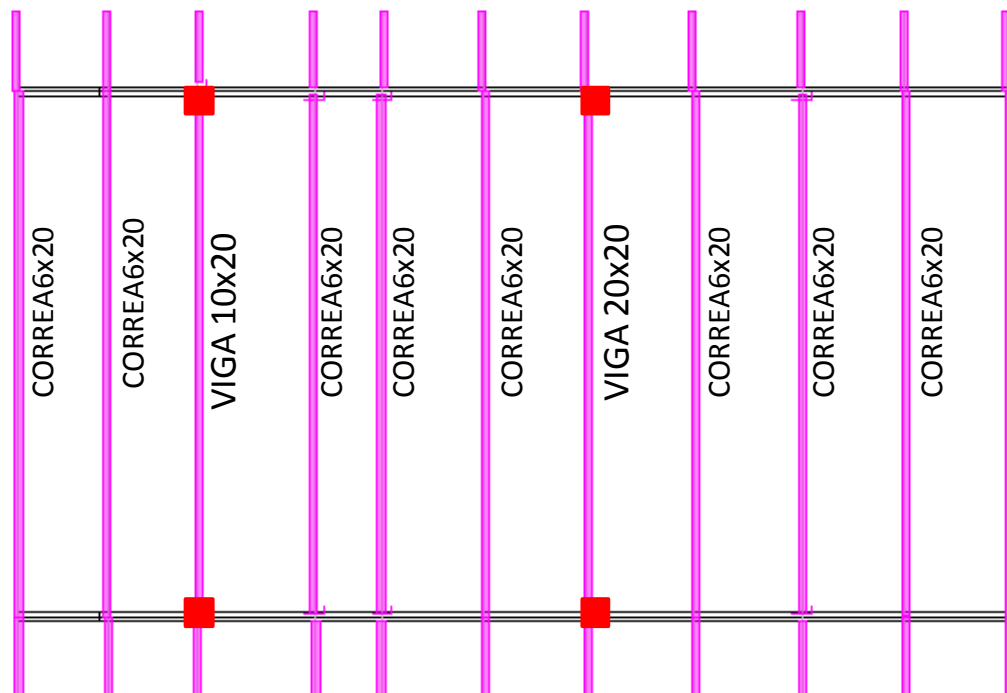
Definición secciones de vigas de cubierta de vivienda de guadua laminada
